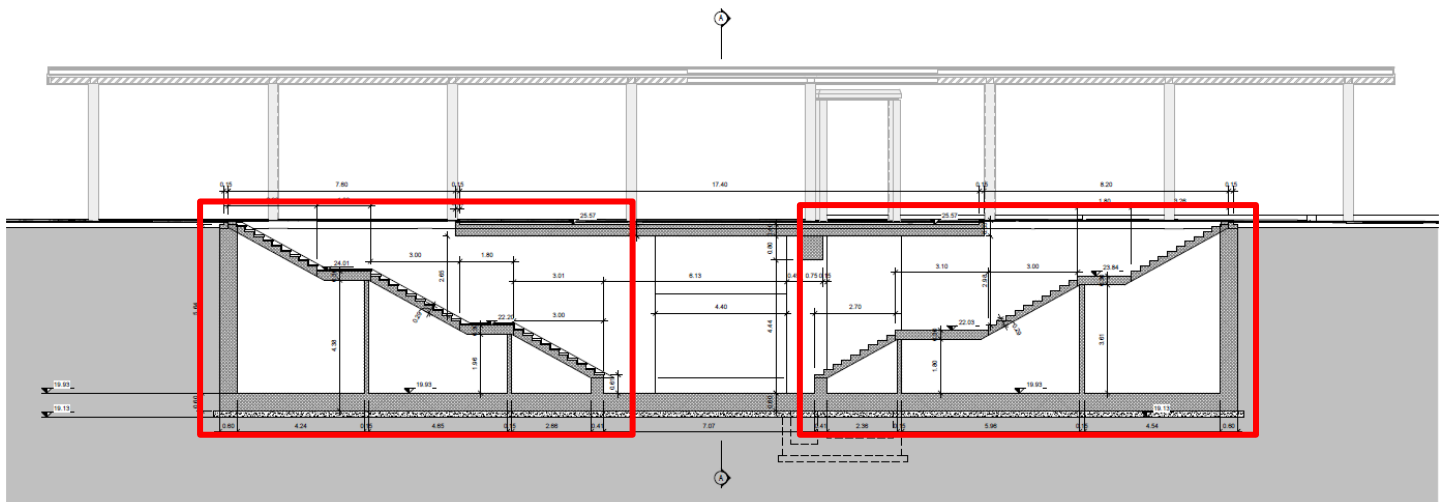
Sezione longitudinale dell'opera con individuazione dei restanti vani scale
